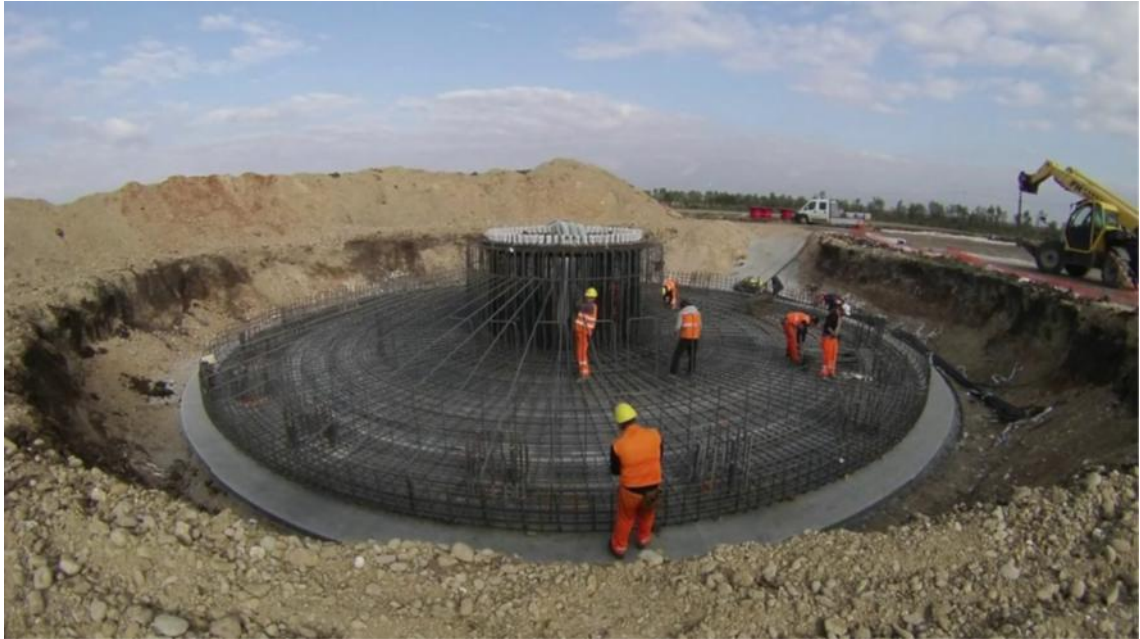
b *Fondazione aerogeneratori: particolare delle armature
